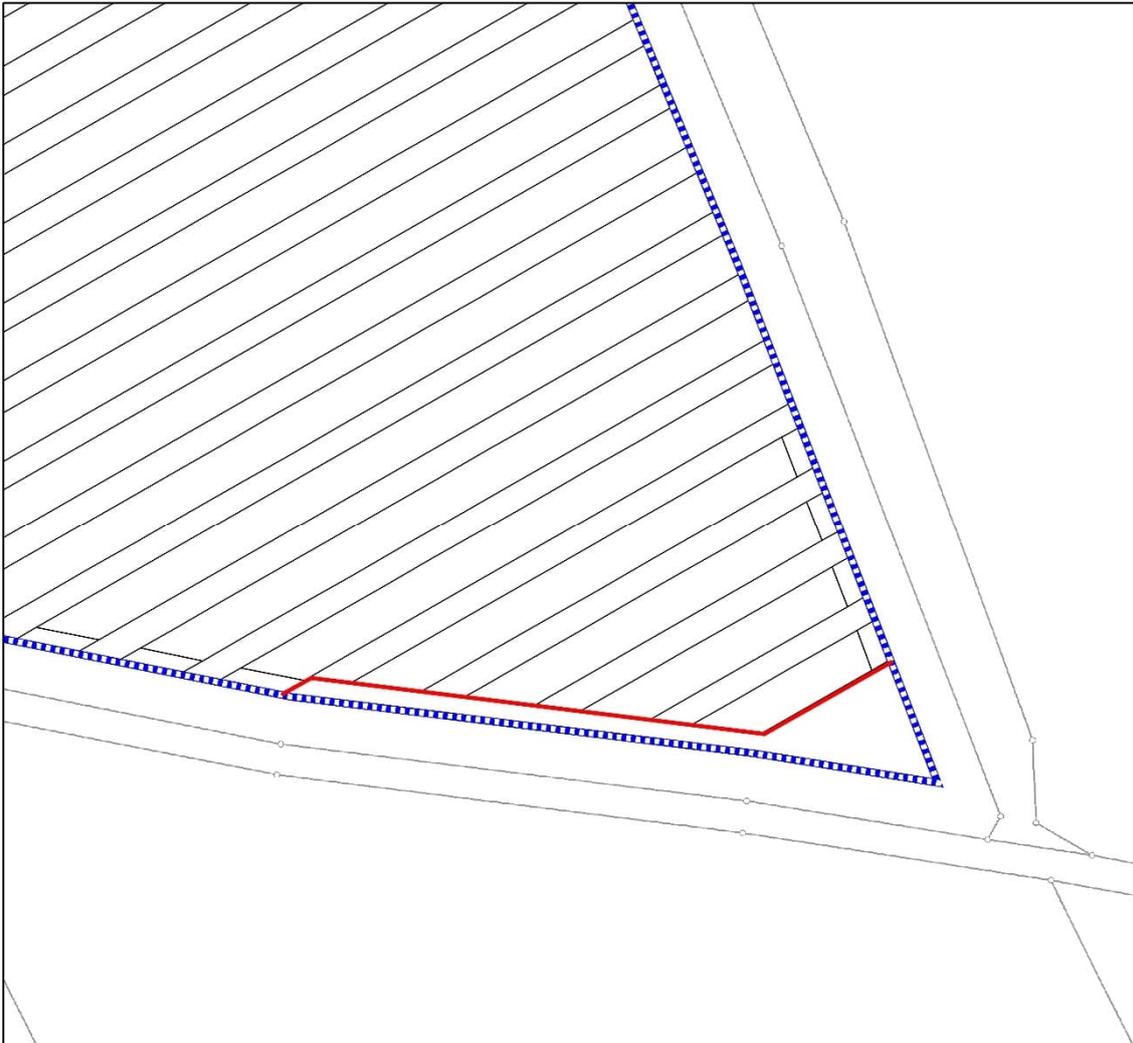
Lageplan mit Detailansicht des Bereichs, innerhalb dessen das Entstehen von Modulen auszuschließen ist
